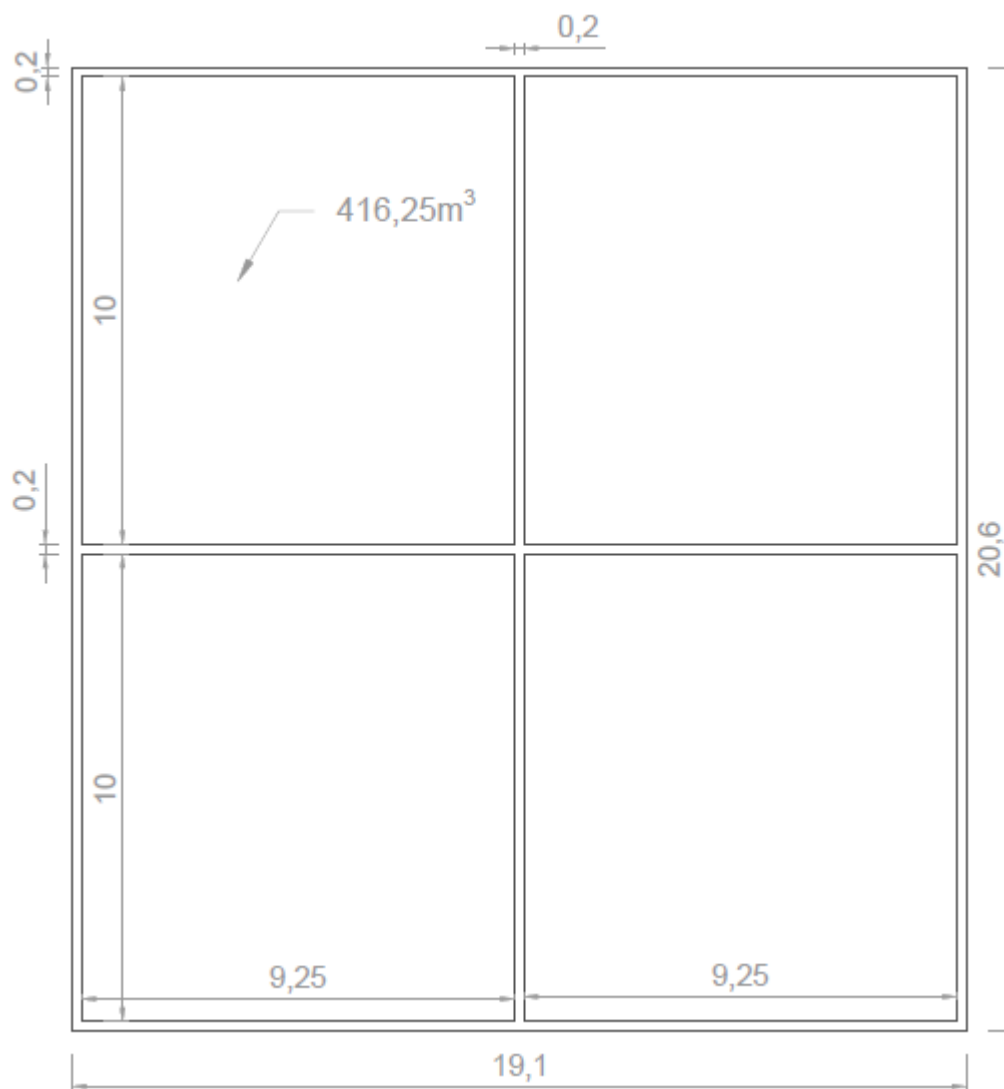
Vista de planta de las cámaras del Fafa propuesto.
